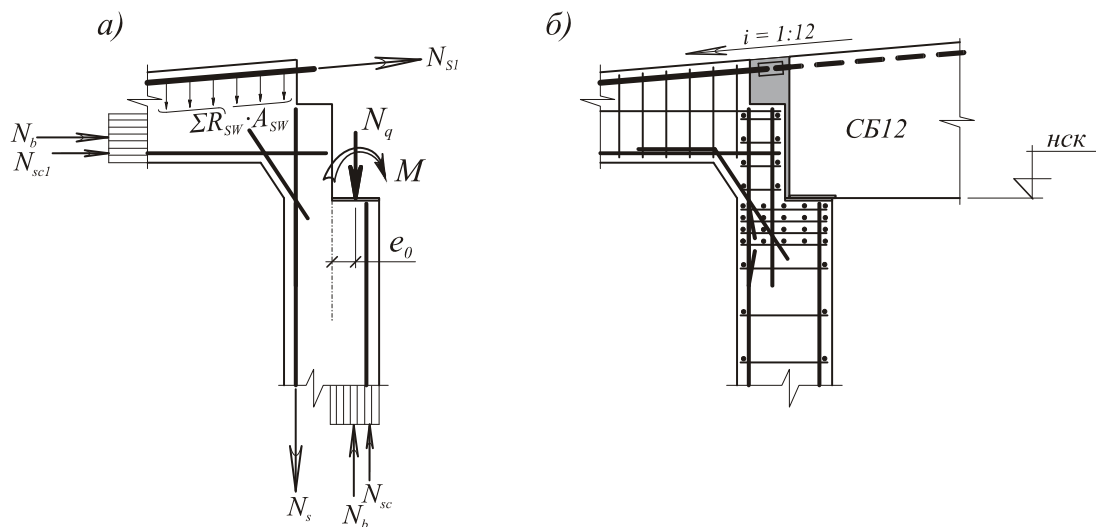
Узел сопряжения рамы ПР-1 и стропильной балки СБ12:
